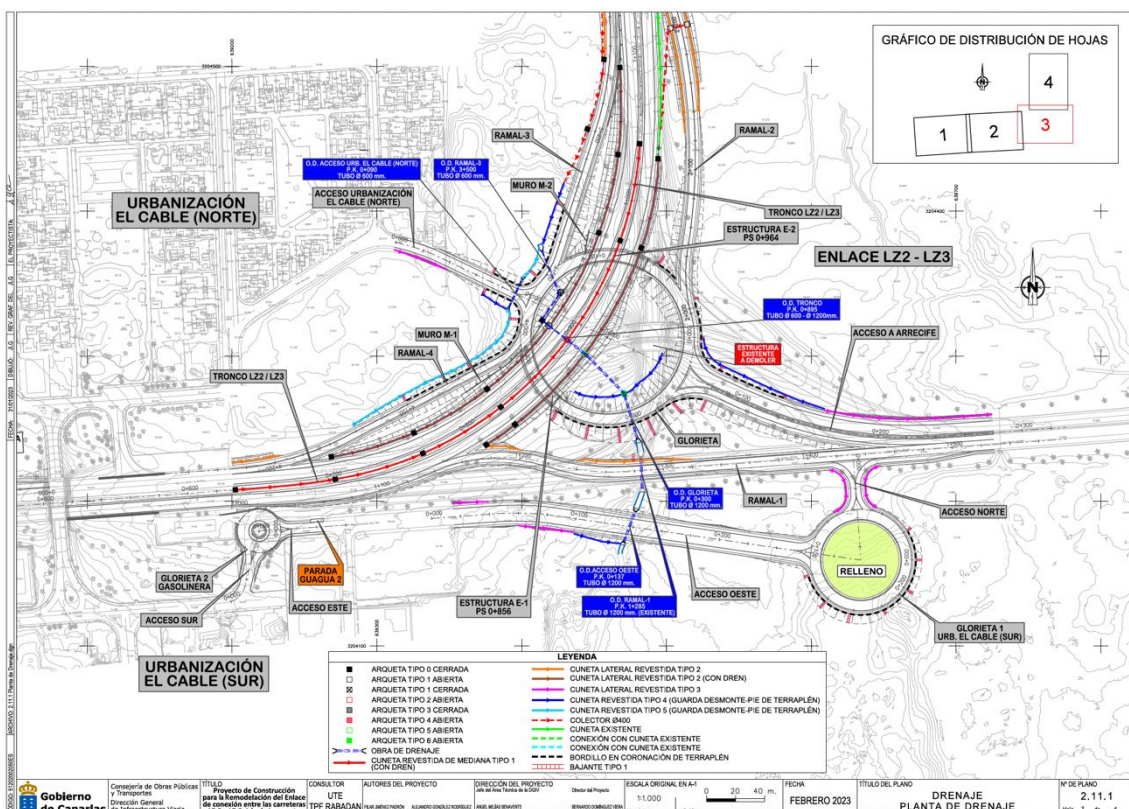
Plano del proyecto presentado por la Consejería de Obras Públicas el Gobierno de Canarias
